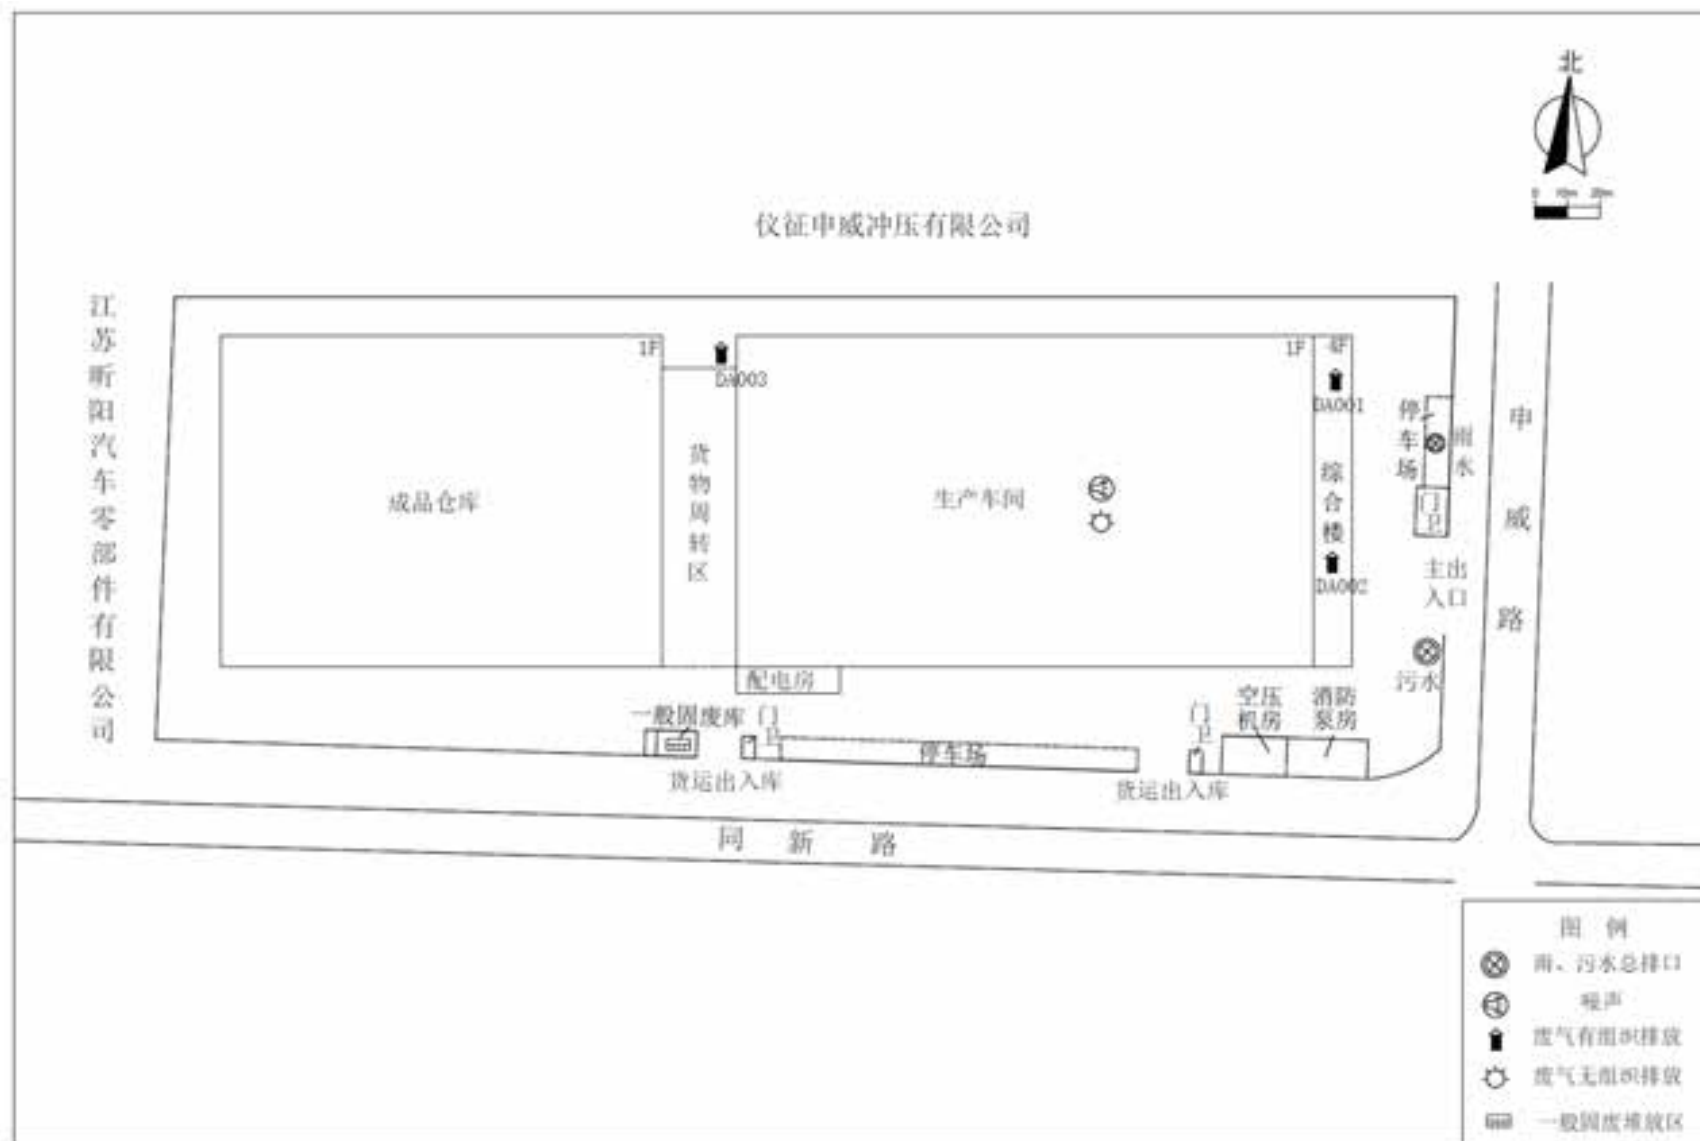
厂区总平面布置图（与环评申报的厂区图基本一致）
